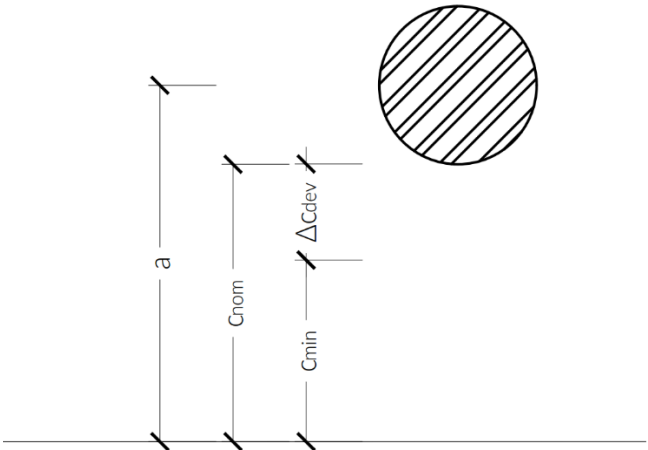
Esquema explicativo de recubrimientos de hormigón para armaduras
